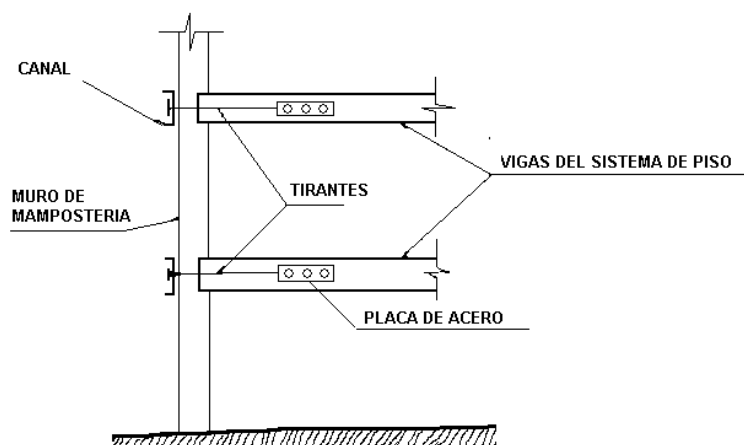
Anclaje de Muro Exterior a Vigas de los Sistemas de piso.
